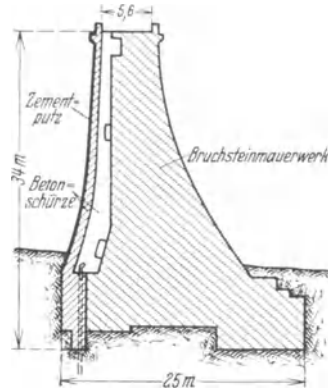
Talsperre aus Bruchsteinmauerwerk, stark beschädigt durch kohlen-säurehaltiges Wasser. Durch eine vorgemauerte Betonschürze wurde das Bruchsteinmauerwerk geschützt und vor weiterer Zerstörung bewahrt.
